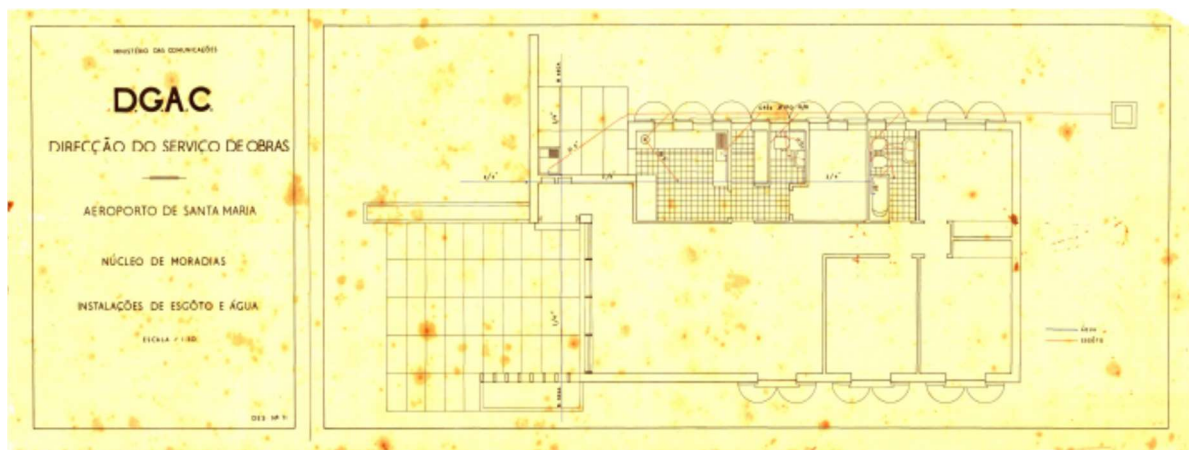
Planta de Habitação Tipo do Bairro de São Pedro (Ilhas de Valor)
